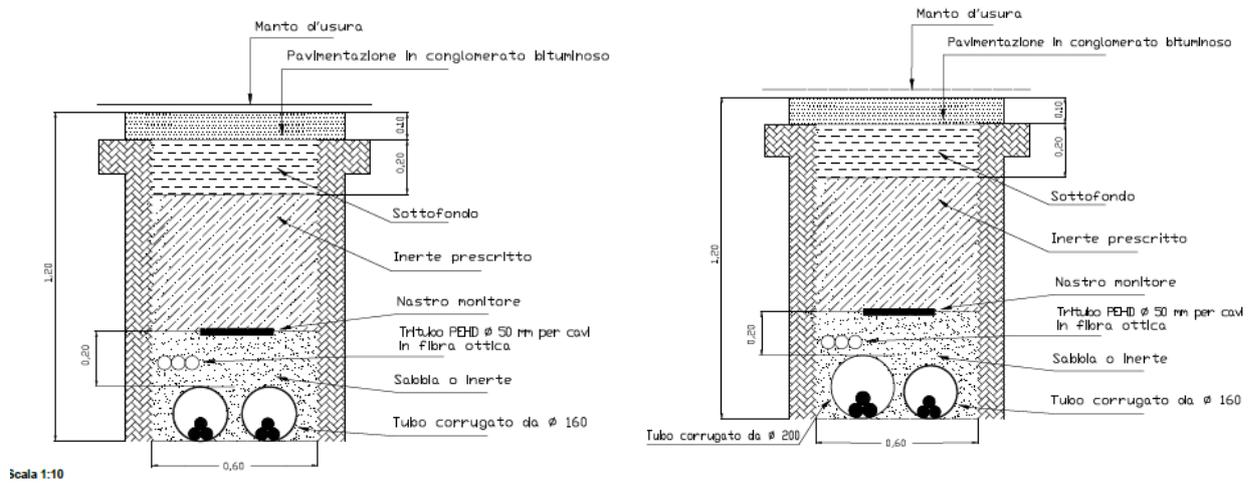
9 Sezione su strada asfaltata - posa di n°2 cavi MT
